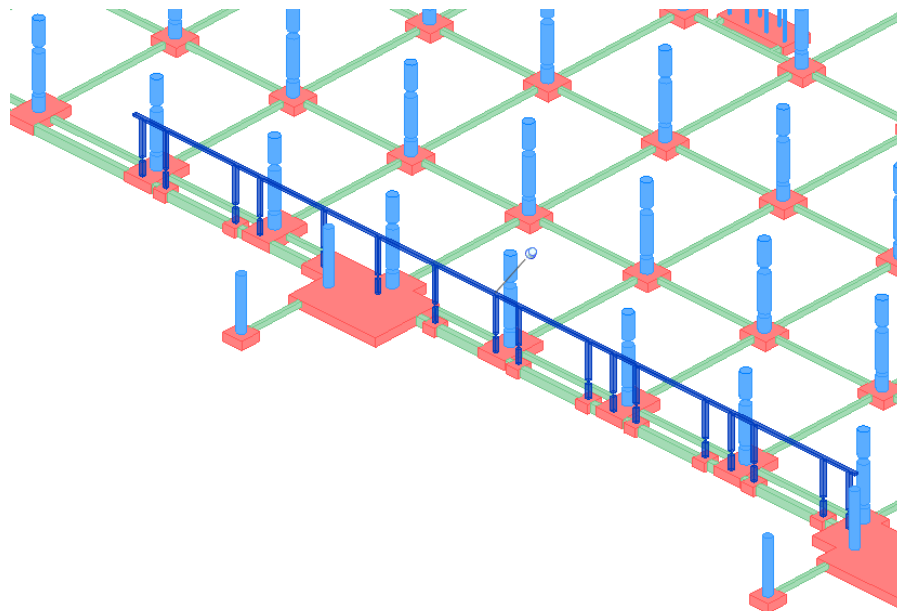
Vista 3D de los pilares y vigas de la zona de acceso a pista, resaltados en azul oscuro.
